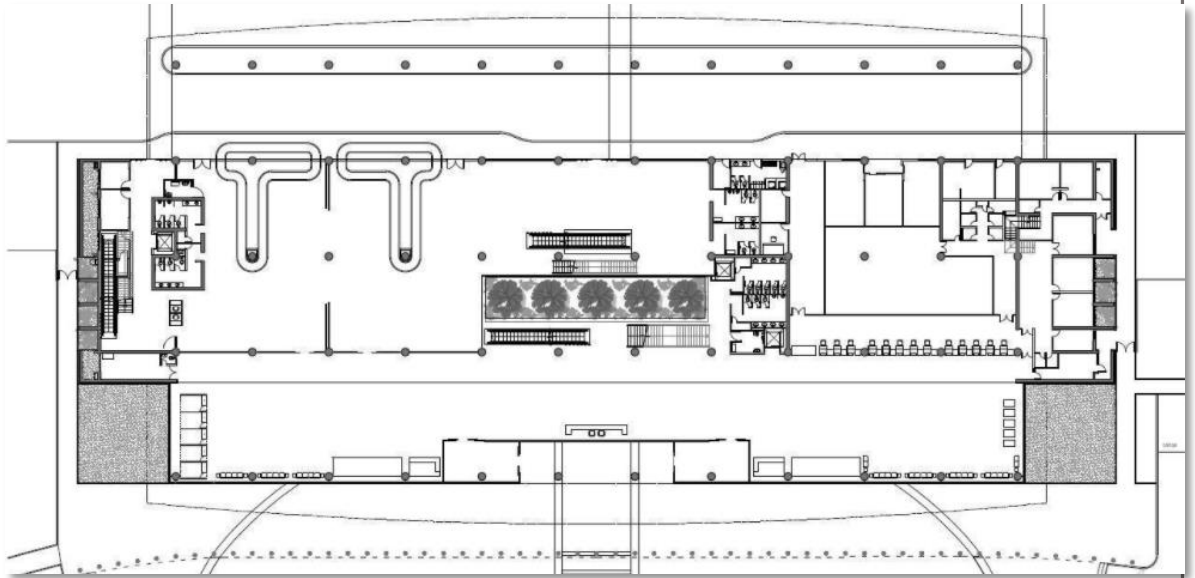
Aeropuerto de la Araucanía, Temuco, Chile – Plano de planta baja. Fuente:
